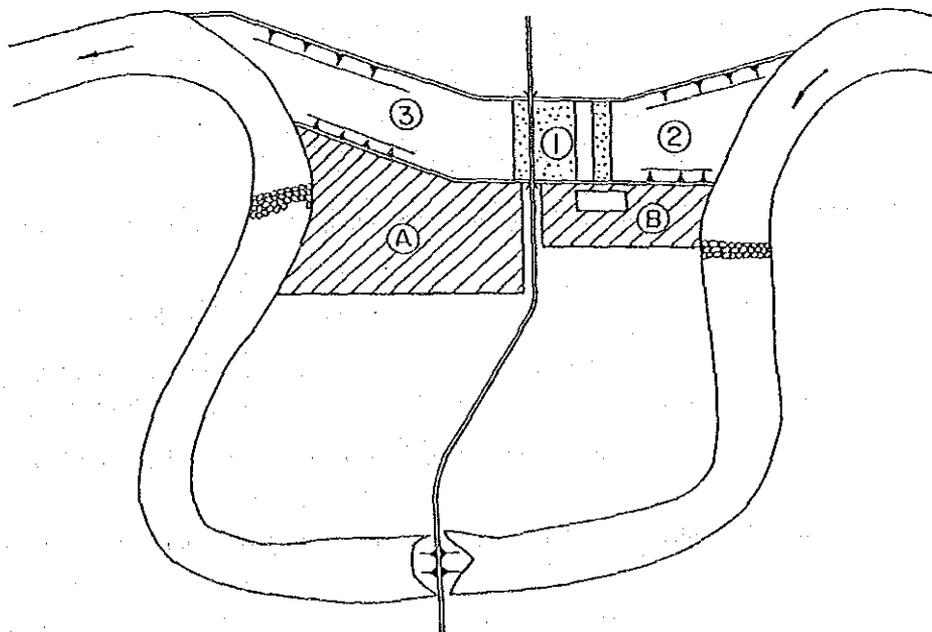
取付水路及び防潮水門部の掘削説明平面図
